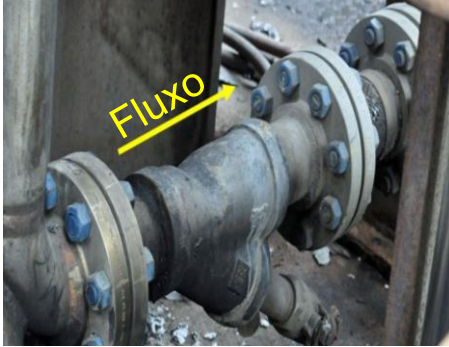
Um filtro em Y de ferro fundido instalado inadequadamente numa linha de aço inox soldada.
